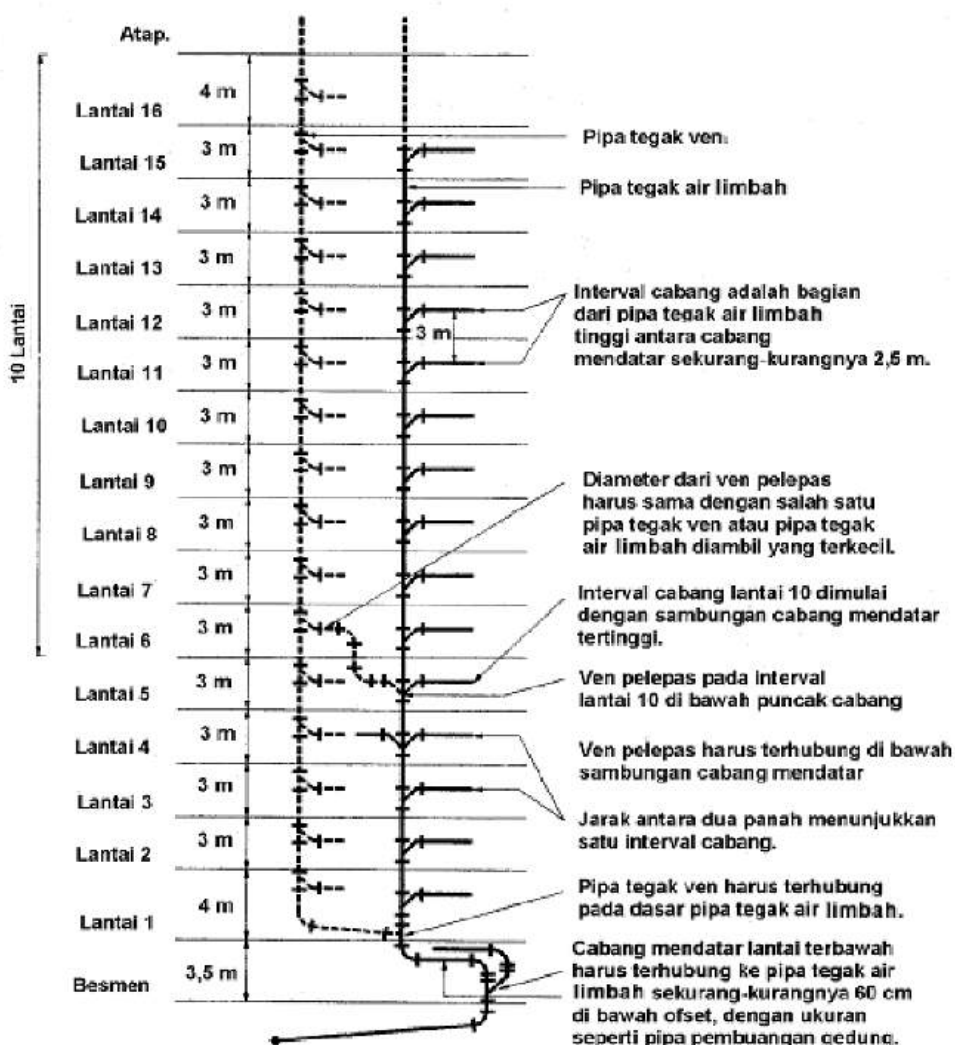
Offset tegak pada saluran pembuangan bangunan gedung
